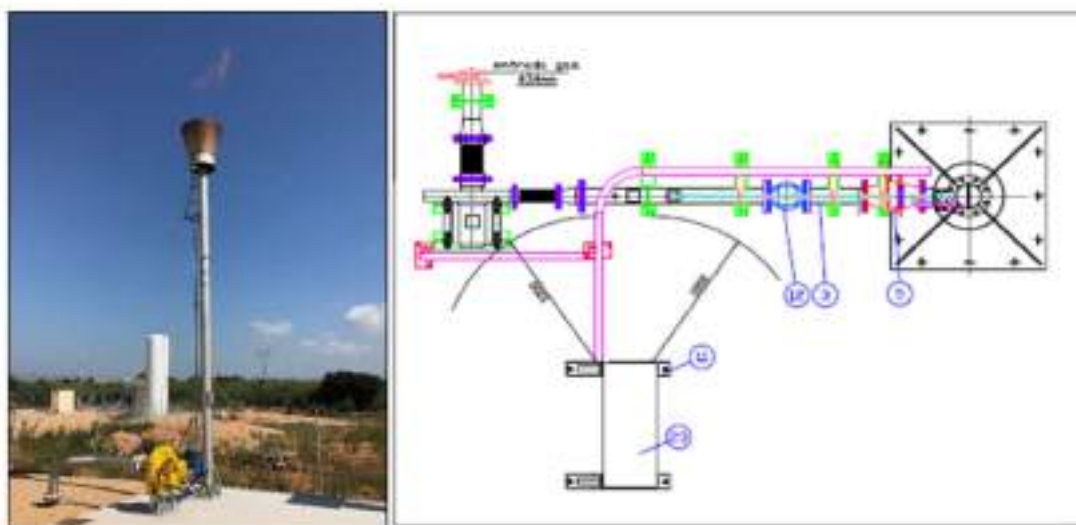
Foto y detalle en planta de antorcha de seguridad.
